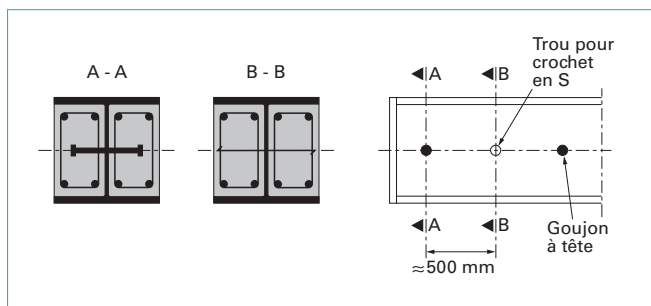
Dispositif d'ancrage pour la fabrication des poteaux mixtes partiellement enrobés
